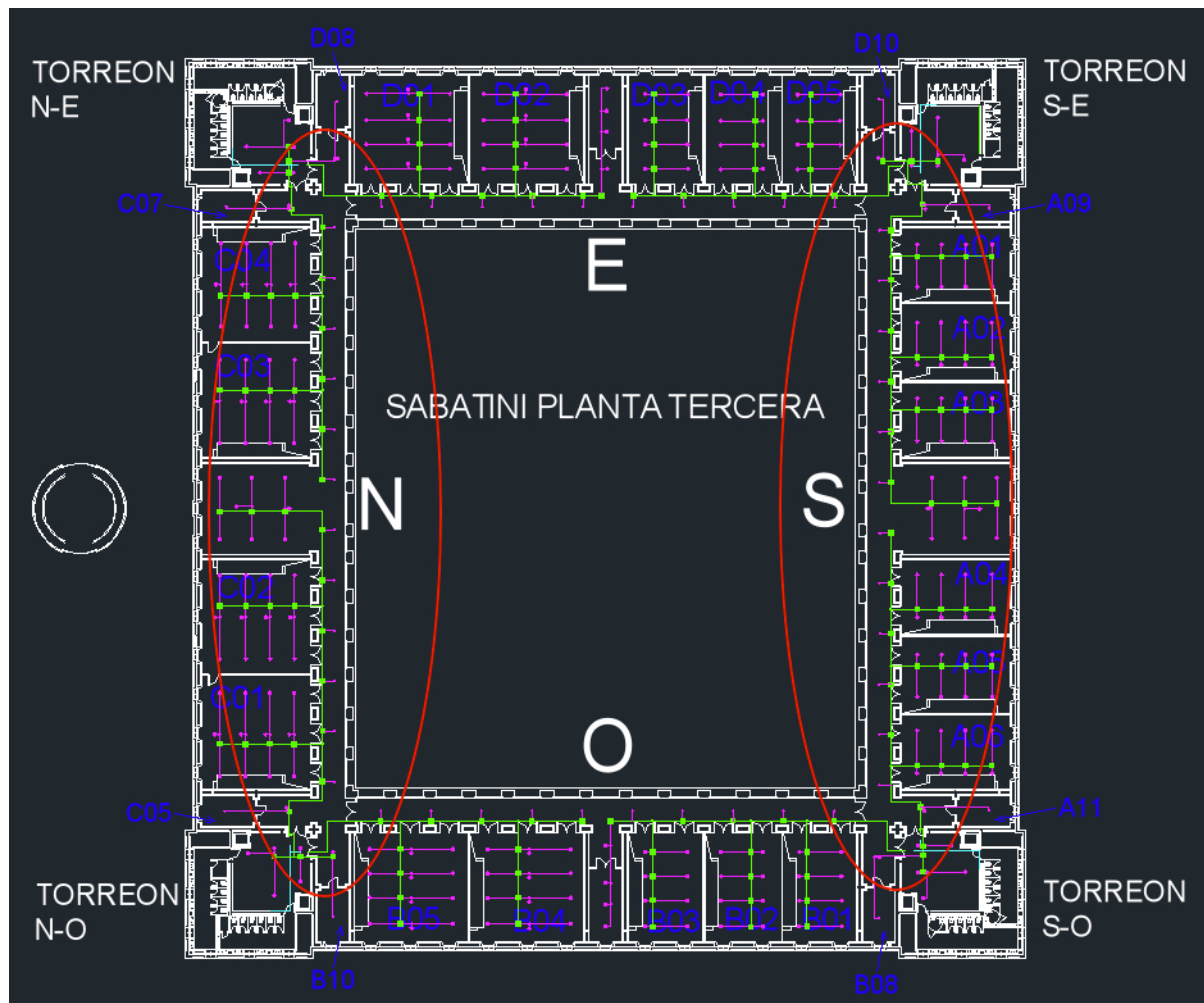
Zonas más desfavorables -Planta Tercera – AutoCAD
